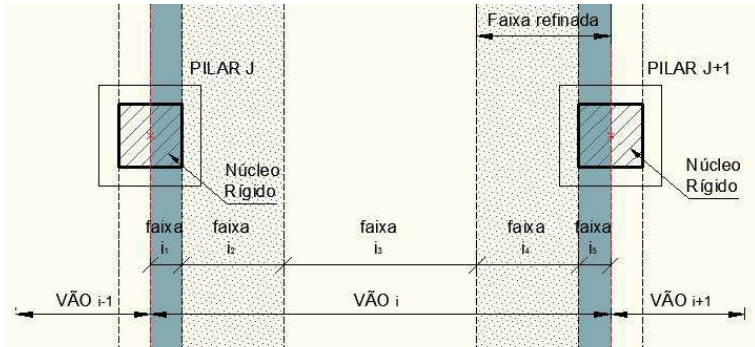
Esquema das faixas verticais do pavimento para um vão qualquer.
